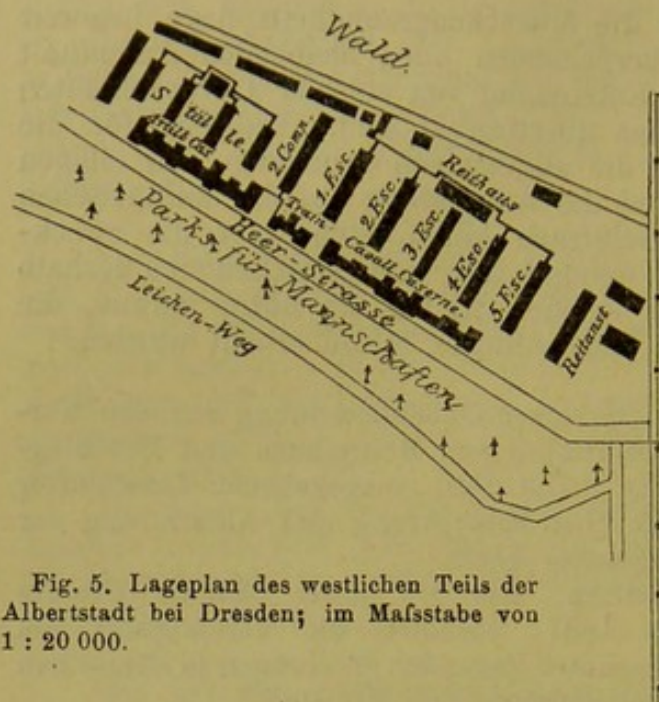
Lageplan des westlichen Teils der Albertstadt bei Dresden; im Maßstabe von 1 : 20 000.
